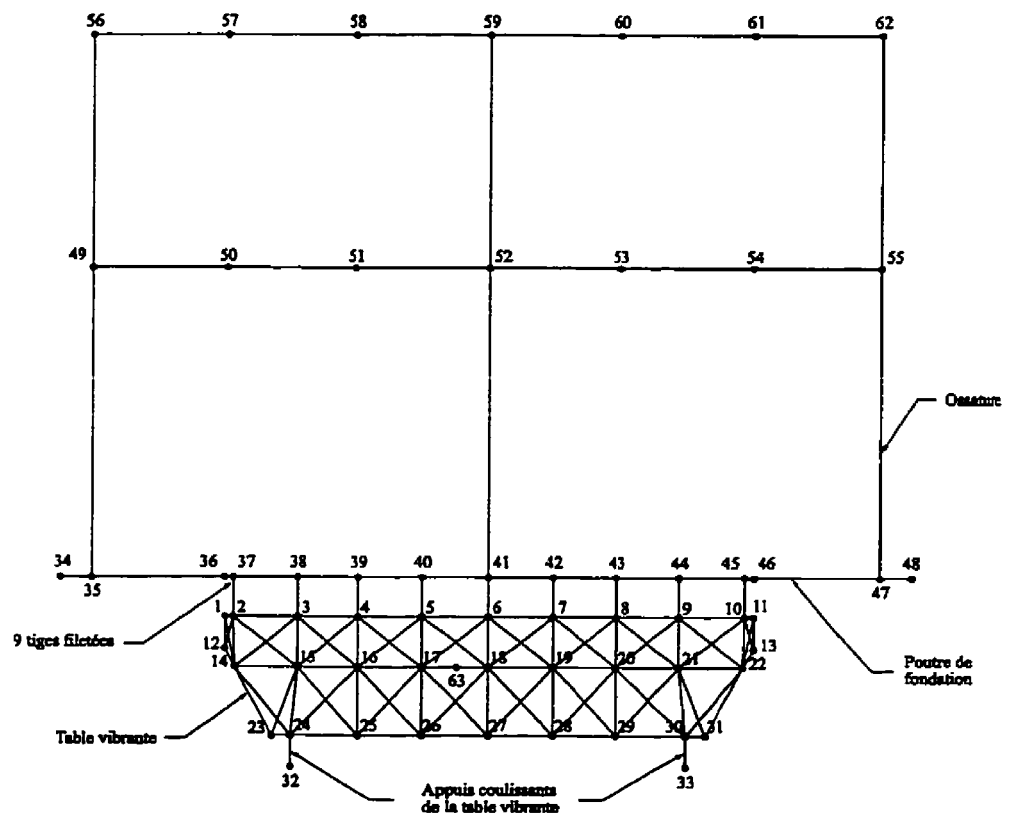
Modèle avec la poutre de fondation et la table vibrante sur SAP90.
